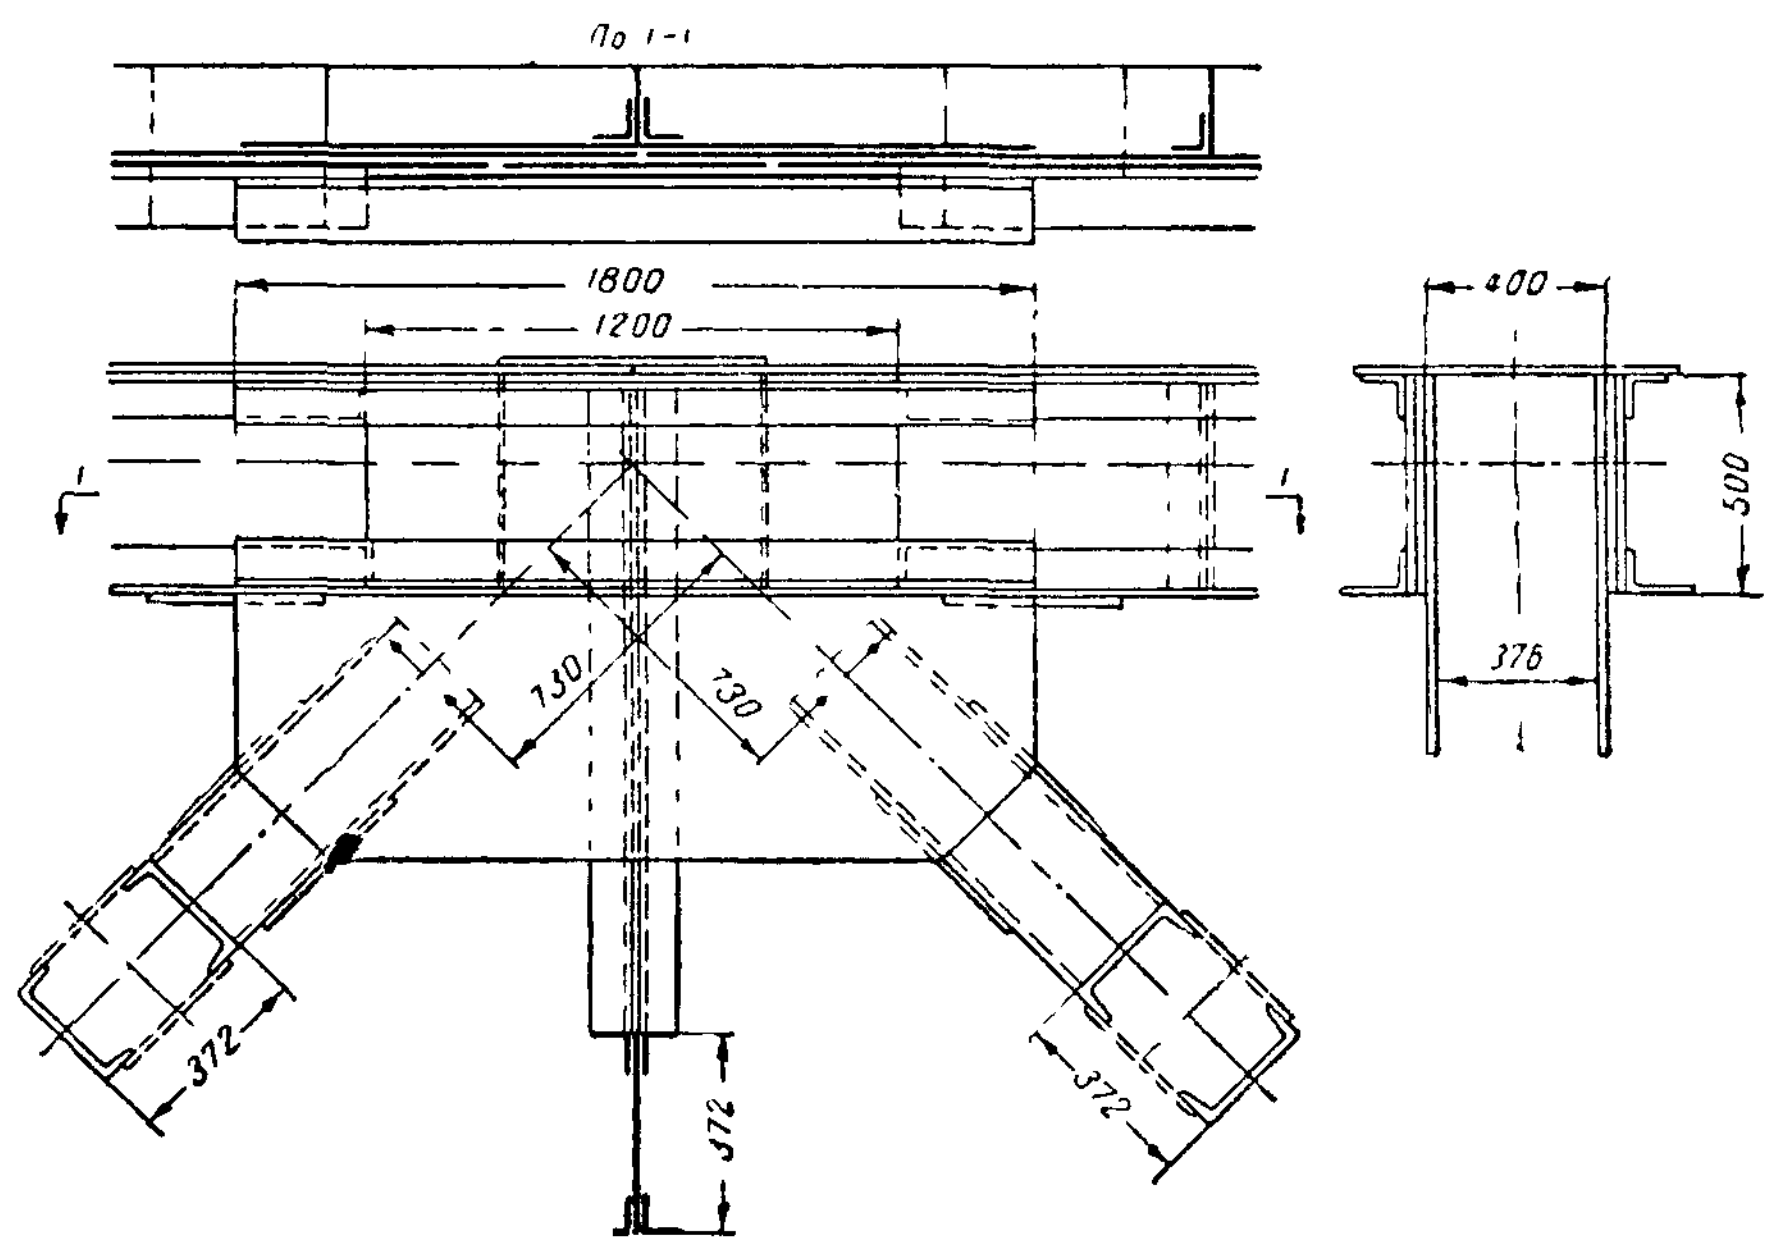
Узел тяжелой фермы при коробчатом сечении пояса
